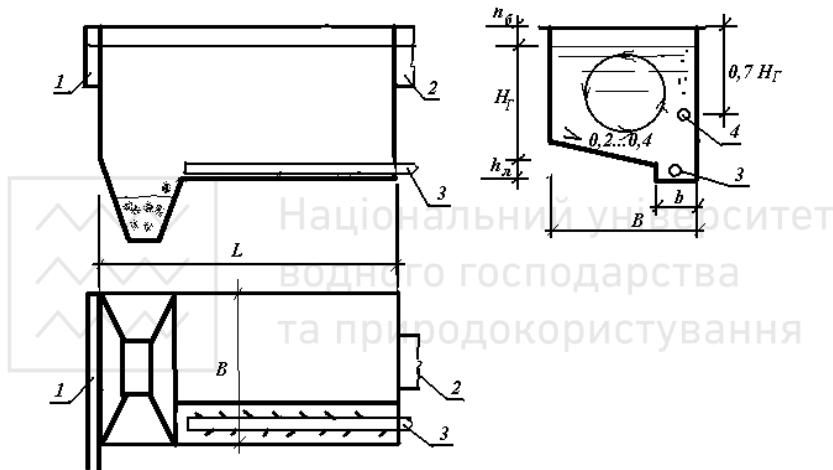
Розрахункова схема аерованого піскоуловлювача
